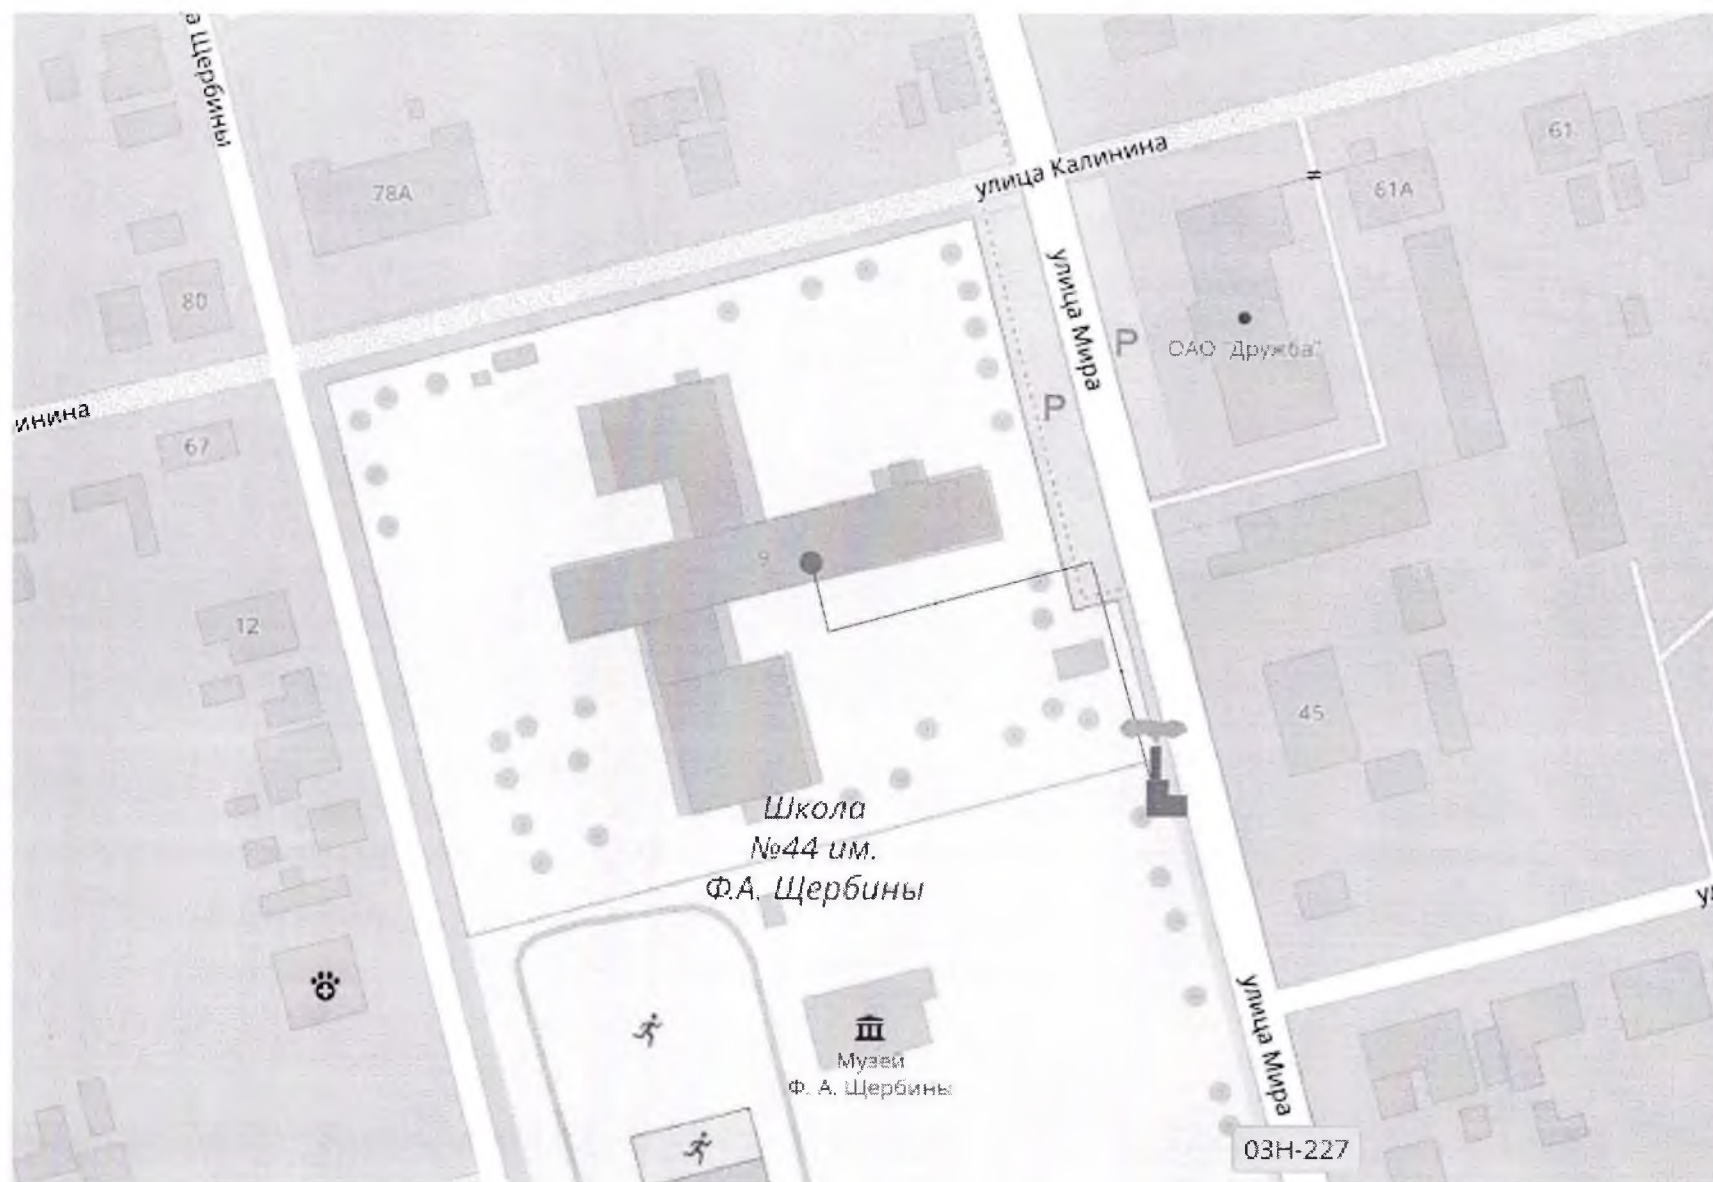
Схема теплоснабжения котельной № 35 «СШ № 44»
